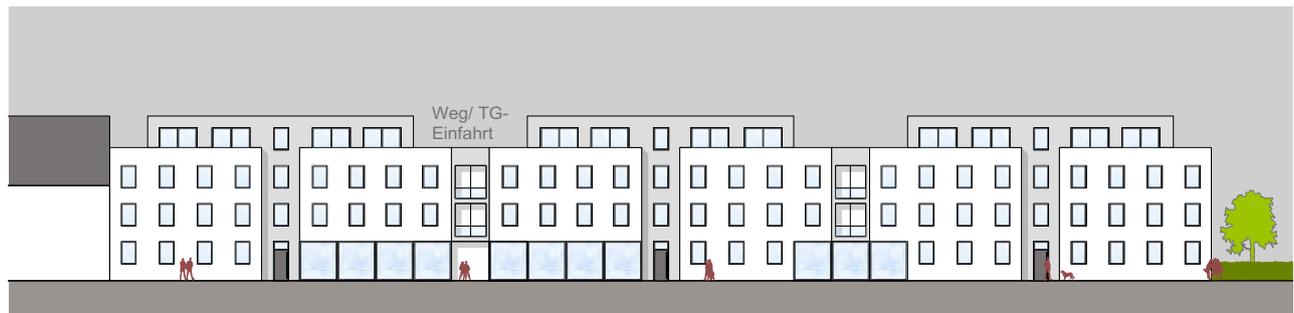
Ansicht Neubebauung Bonner Straße mit Staffelgeschoss
